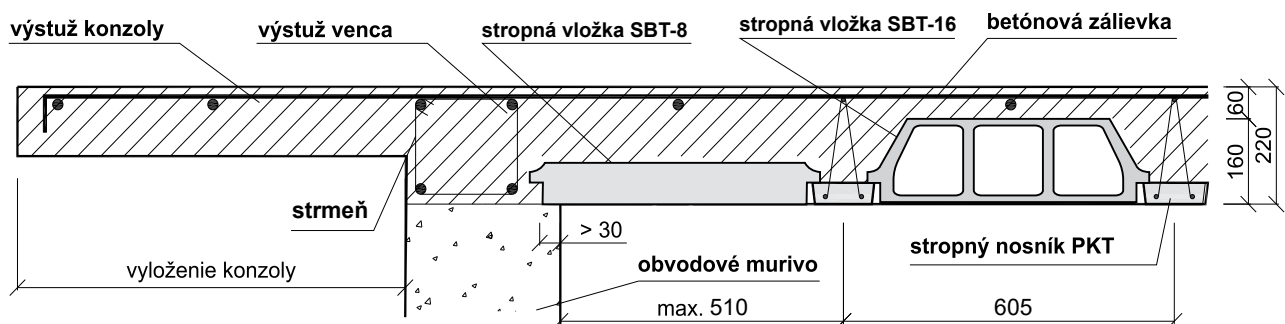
DETAIL REZU ULOŽENIA STROPU NA PRIEVLAK
